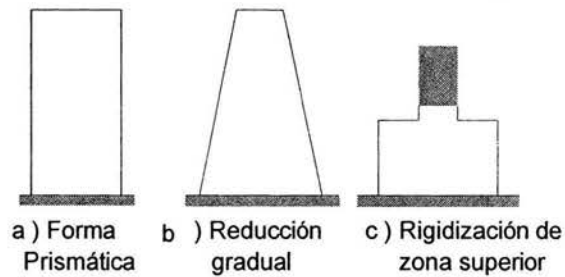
Posibles soluciones a la reducción en elevación (Meli, Bazan 1998)
